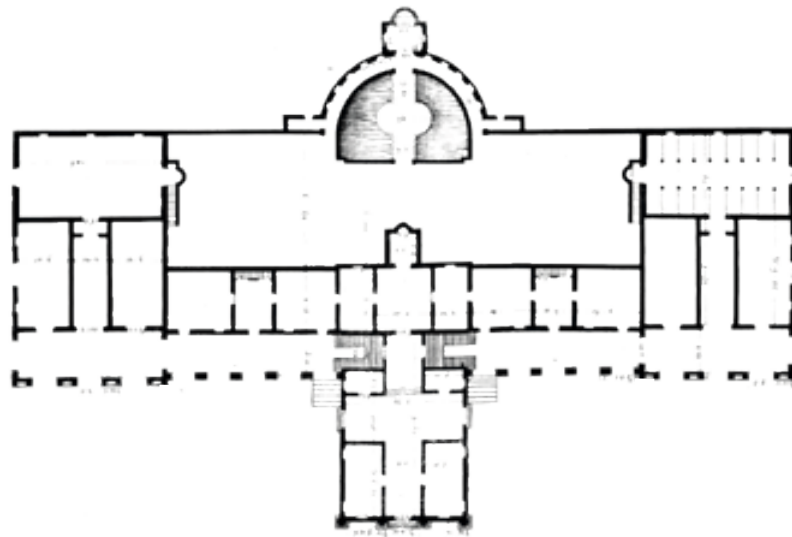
Grundriss Villa Barbaro | 0 | 20m
